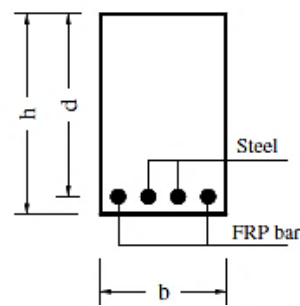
Detalles de sección transversal con refuerzo híbrido utilizando en simultáneo barras de acero y barras de PRF [37].
